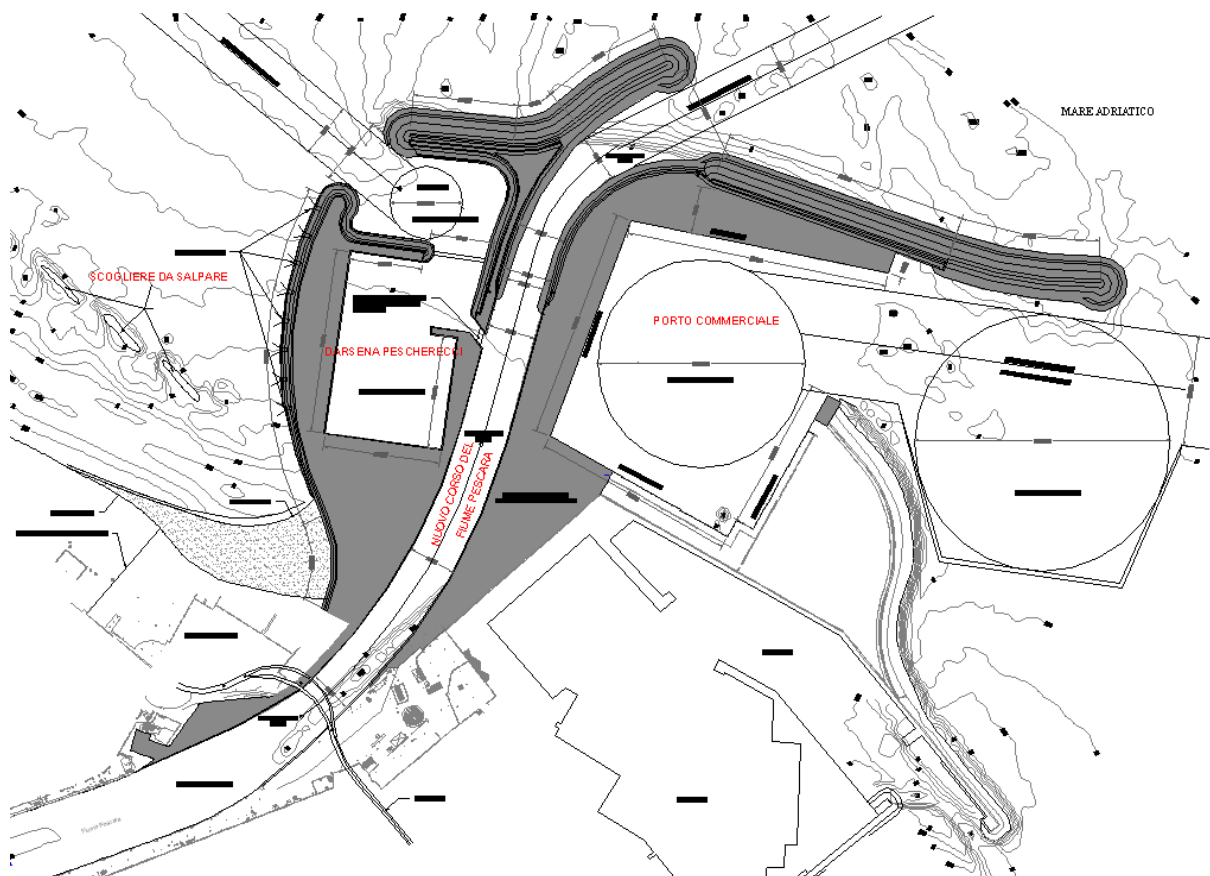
Planimetria del Piano Regolatore Portuale 2008 (PRP) – Estratto Tavola M7.
